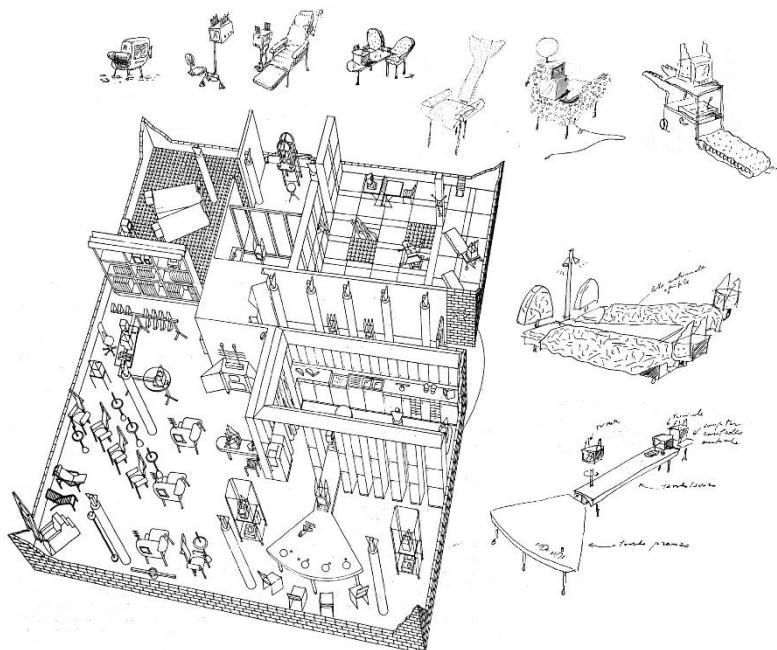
Casa Telemática, Ugo La Pietra, Feria Internacional de Milán (1983).
